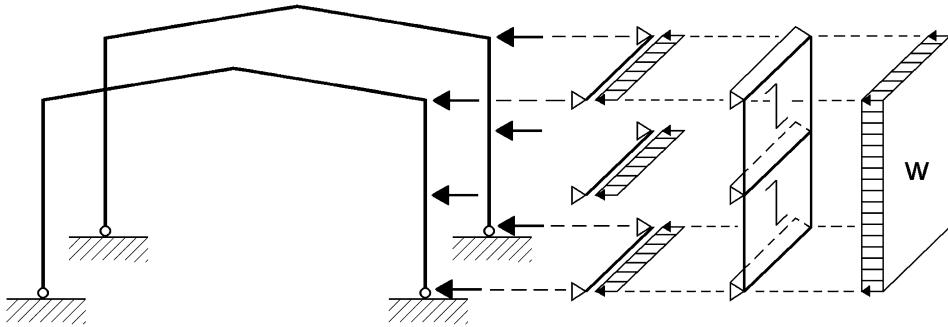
Abtragung der Horizontallasten in Hallenquerrichtung bei Hallen ohne Wandriegel
